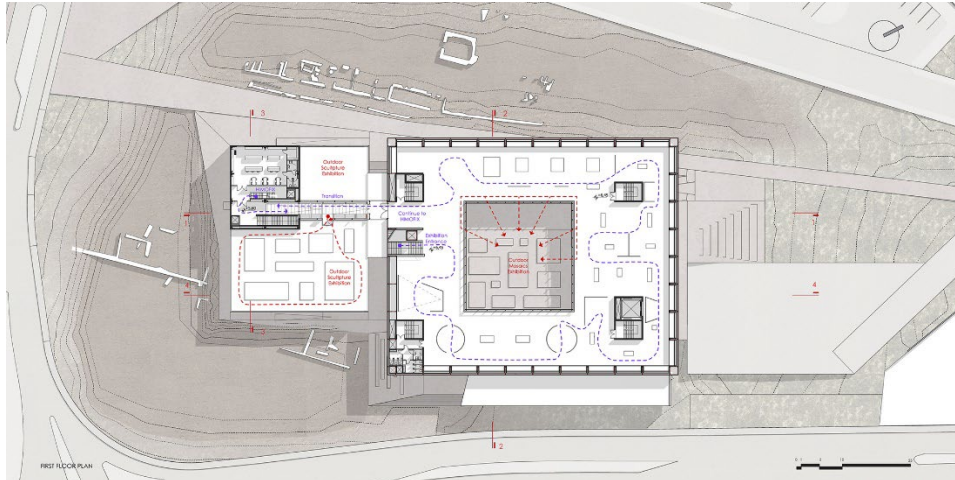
Le plan de premier étage de musée de sparte. (archdaiy.com)
